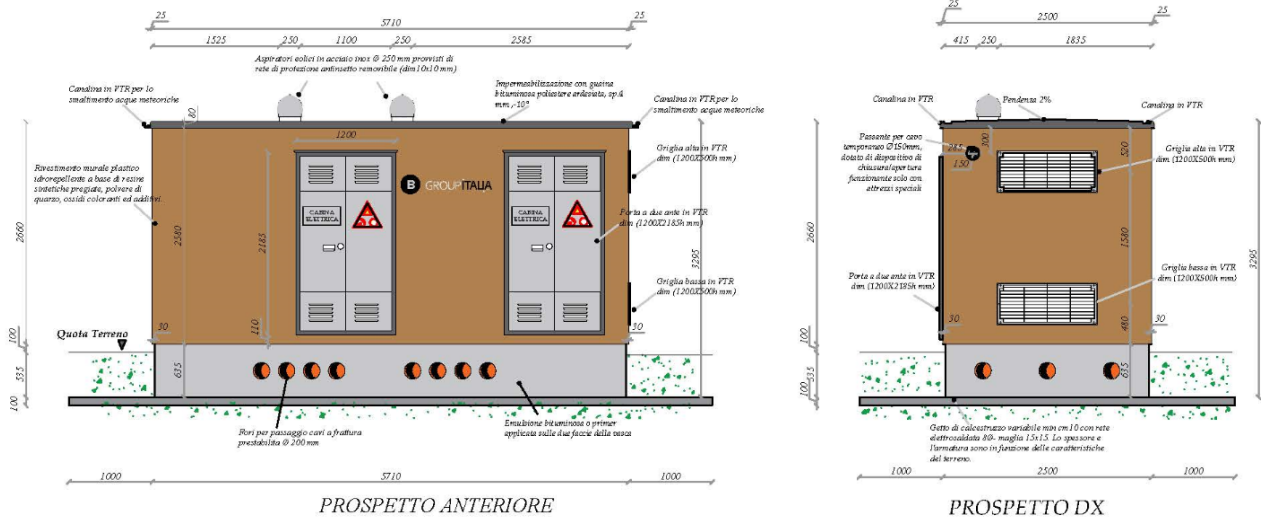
Prospetti della cabina cabina di sezionamento modello DG 2061 ed.VIII.
